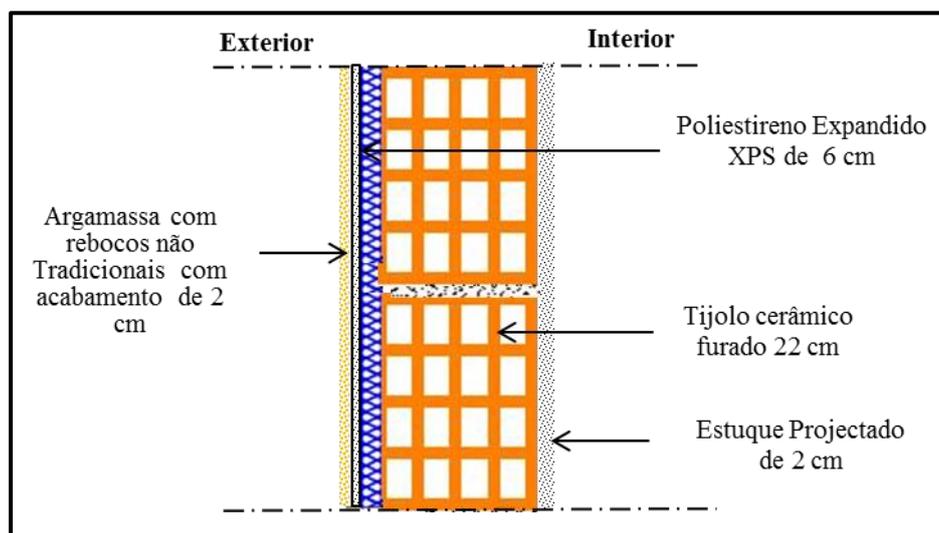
Pormenor Construtivo - PE com isolamento pelo Exterior - XPS
